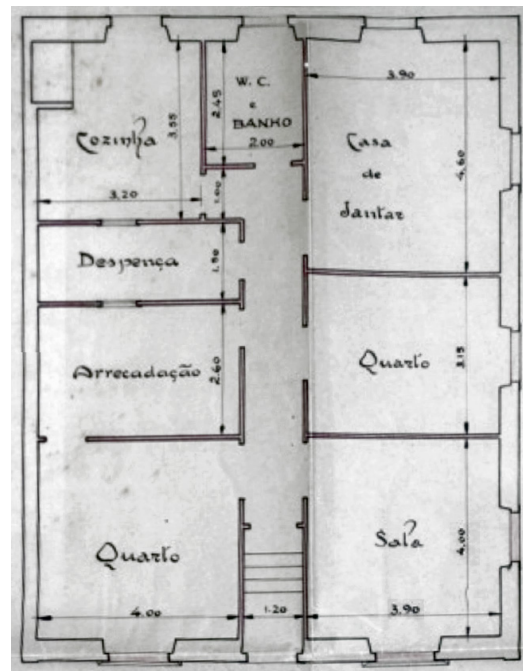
Planta Projeto Tipo. Fonte: Câmara Municipal de Setúbal, 2009.
